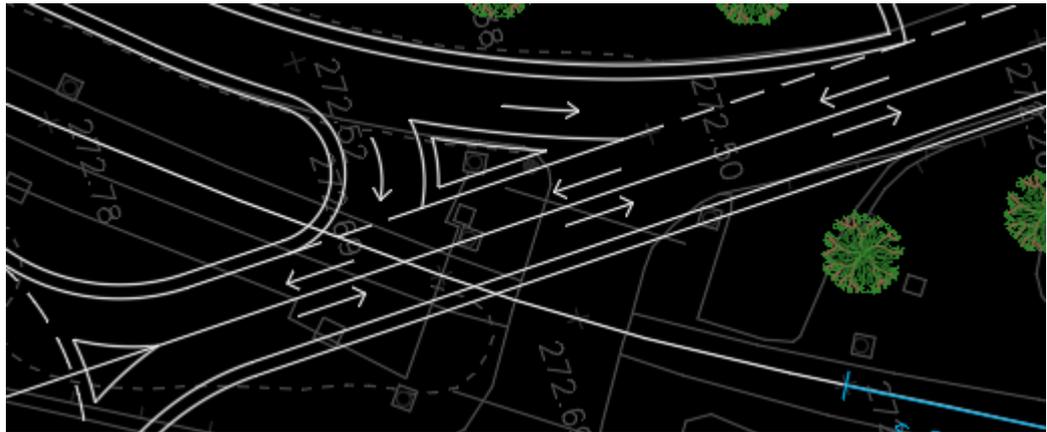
Estratto Autocad intersezione stradale uscita Modalohr 1 e strada di collegamento con Strada del Portone
